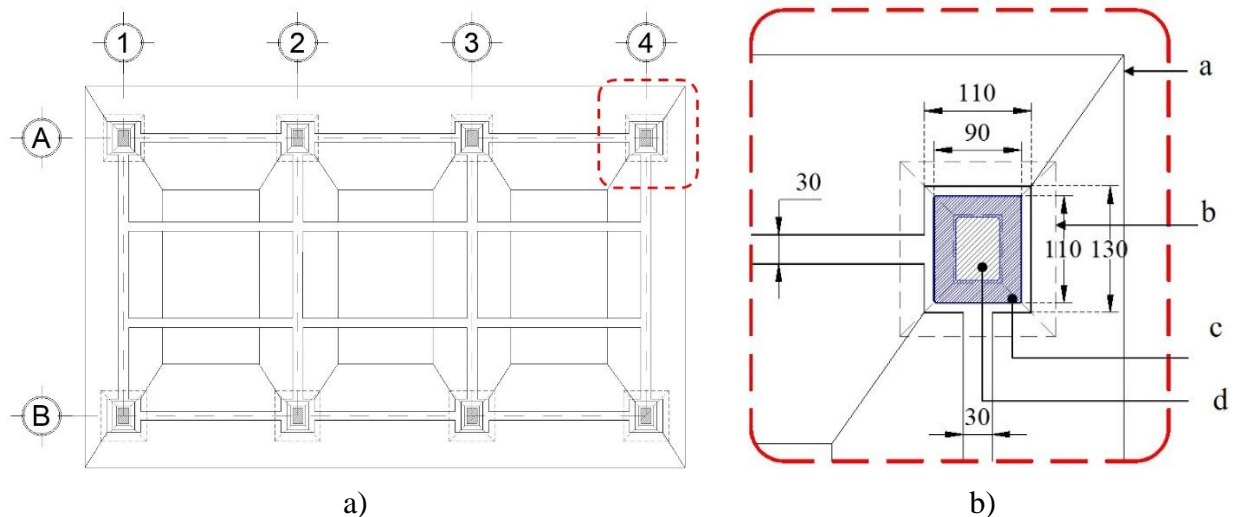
Encamisamento em pilares e fundação; a) vista em planta da fundação encamisada; b) vista em planta de encamisamento de sapata e pilar de concreto armado existente; onde: a = reforço de fundação à base de sapatas corridas, b = projeção de sapata isolada existente, c = encamisamento em concreto armado em pilar existente, d = pilar de concreto armado existente.
